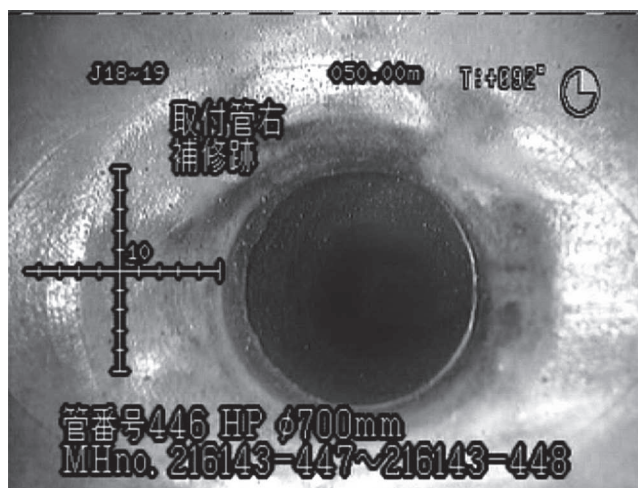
宮城県 ϕ 700mm取付管接合部一体型
